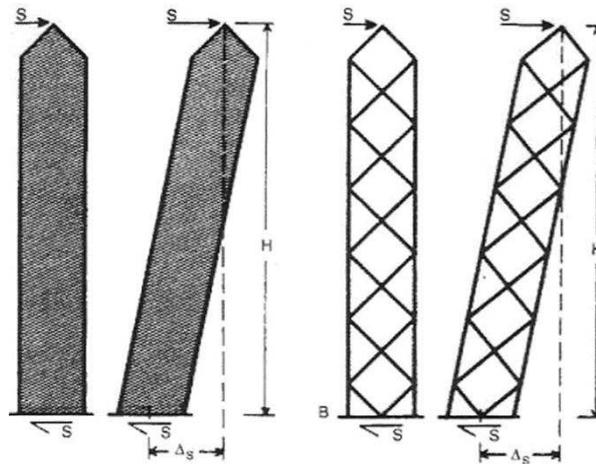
Sistemas resistentes a cortante de edificios en altura: a) Pantallas macizas de hormigón, b) Vigas trianguladas metálicas. (Imagen tomada de [Gómez Hermoso et al. 2013, 98]).
